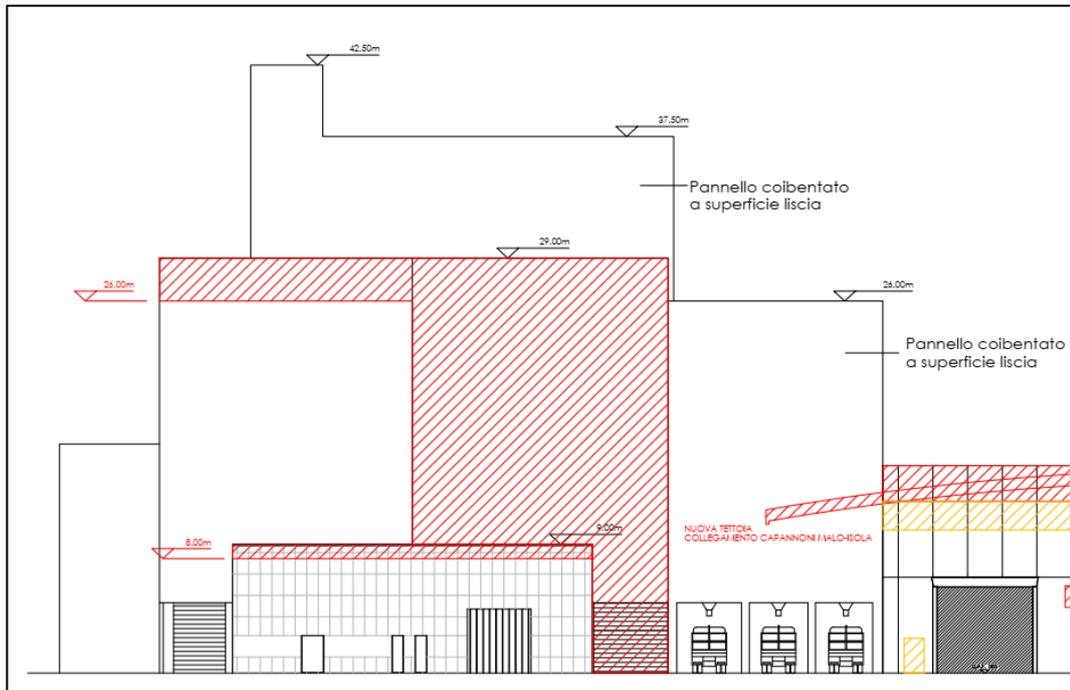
MODIFICHE PROSPETTICHE ALL'EDIFICIO A E B, VISTE DA SUD, CON REALIZZAZIONE VANO MONTACARICHI E INNALZAMENTO A 29 M
